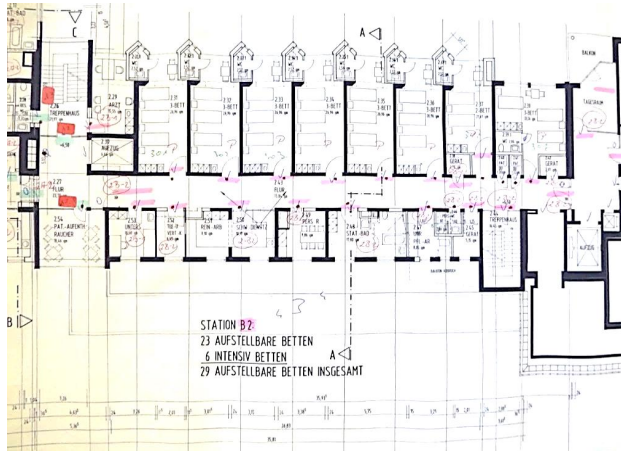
Veralteter Grundriss des Krankenhauses Bad Pymont, 2.OG
